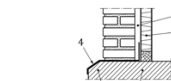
Mur de type III avec maçonnerie apparente et bandeau saillant
